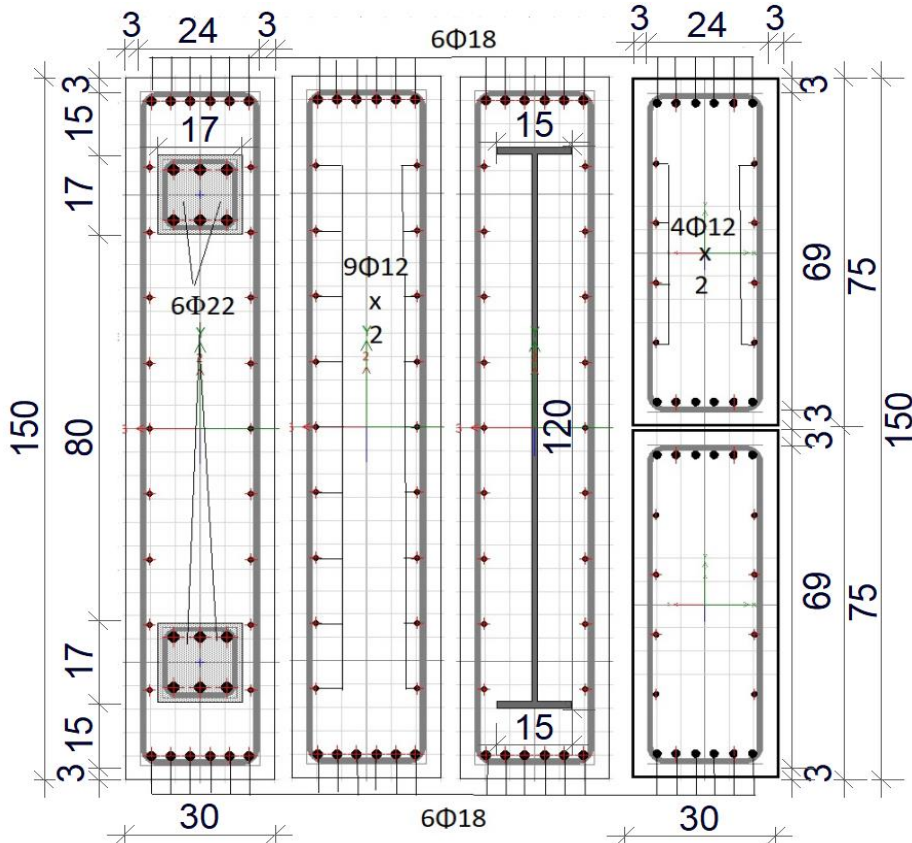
Ba ğ Kirişlerinde Çift Kiriş Modeli (Choi vd., 2018) (Double Beam Model on Coupling Beams)
